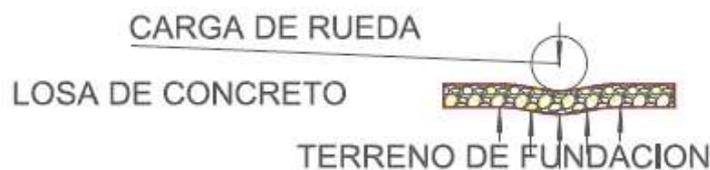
Transferencia de carga de una rueda en una estructura de pavimento rígido
